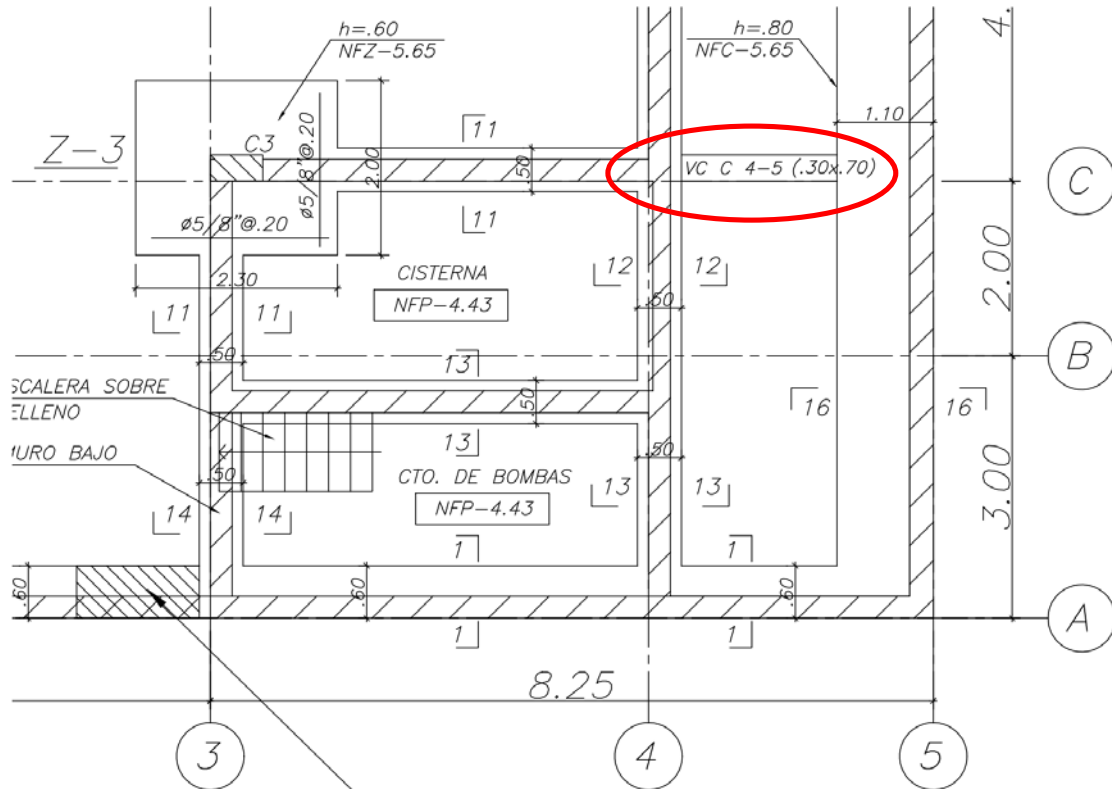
Ubicación de la Viga de Cimentación “VC C 4-5”
